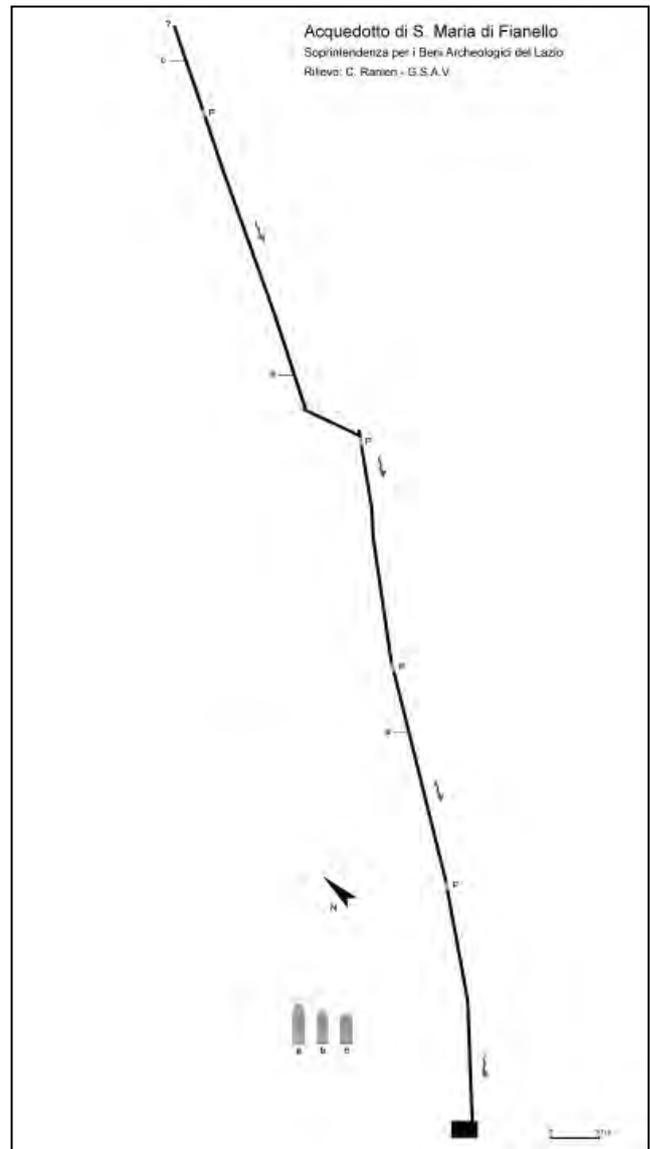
Pianta e sezioni dell'acquedotto di S. Maria di Fianello (rilievo C. Ranieri).
